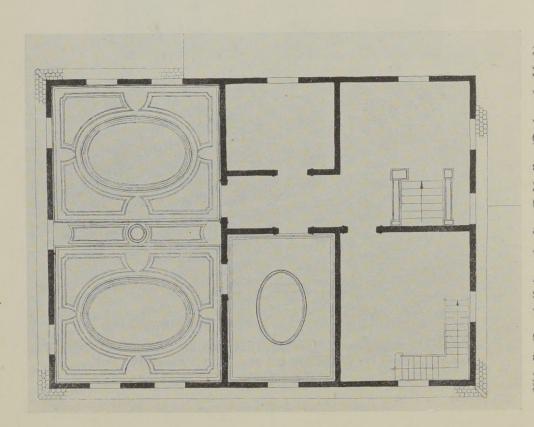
Grundriß des obersten Geschosses (Fachwerkgeschoß).
